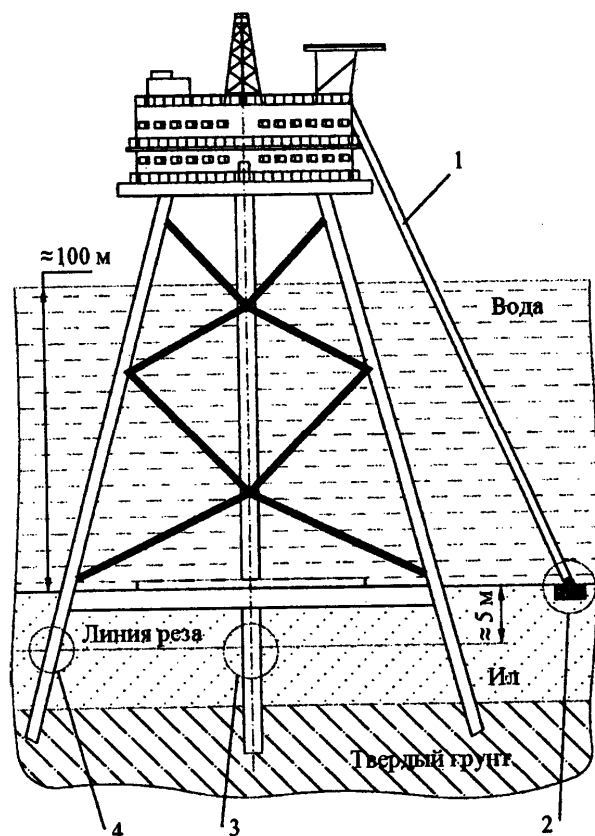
Схема глубоководной нефтегазовой платформы:
